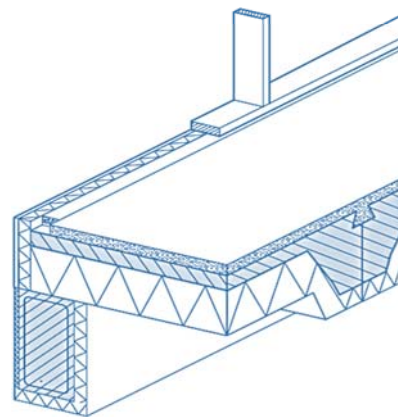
Fundering – beton begane grond vloer (Jellema 3, 2004)
